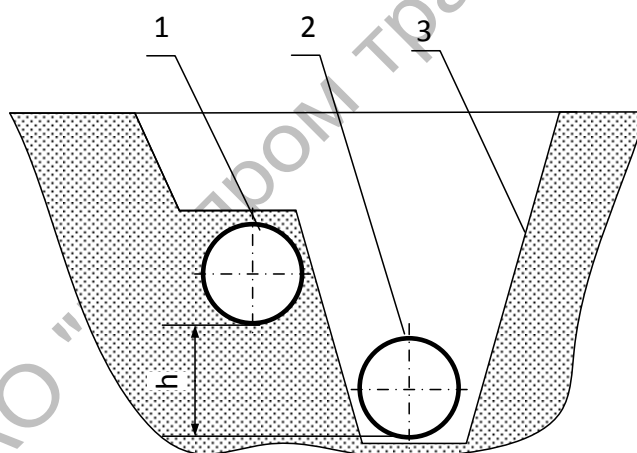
Профиль траншеи при ремонте с заменой труб путем укладки в единую траншею ниже заменяемого трубопровода
